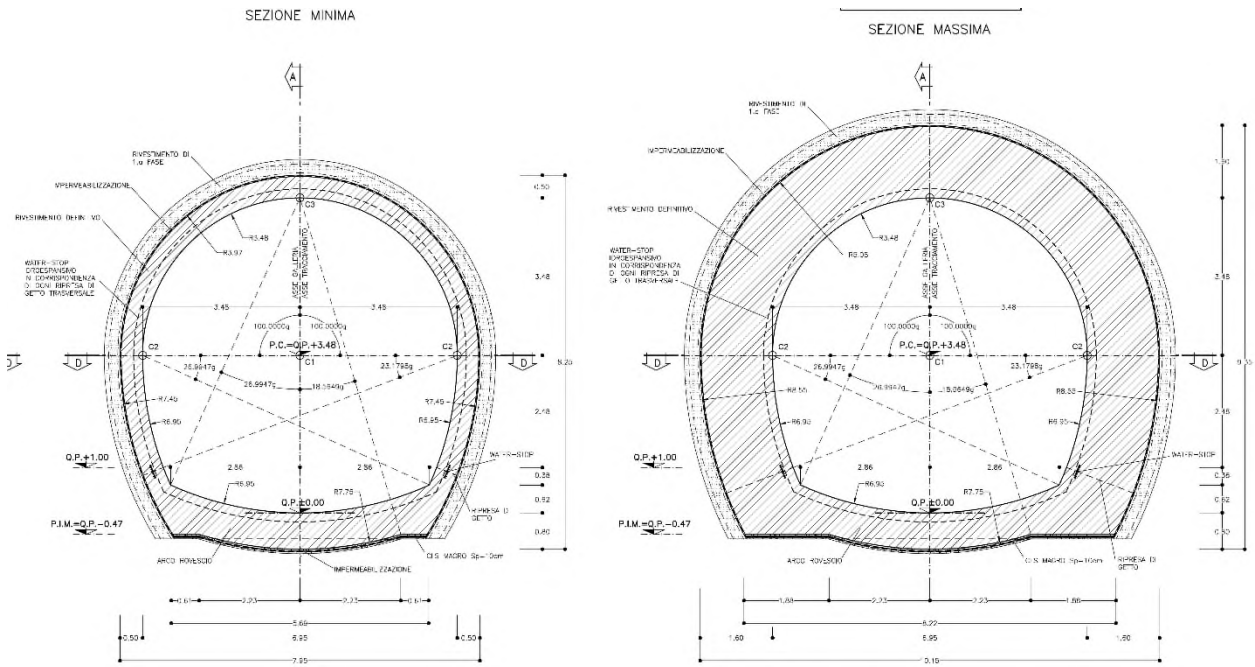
Sezione Tipo C1 – Carpenteria – Sezioni
